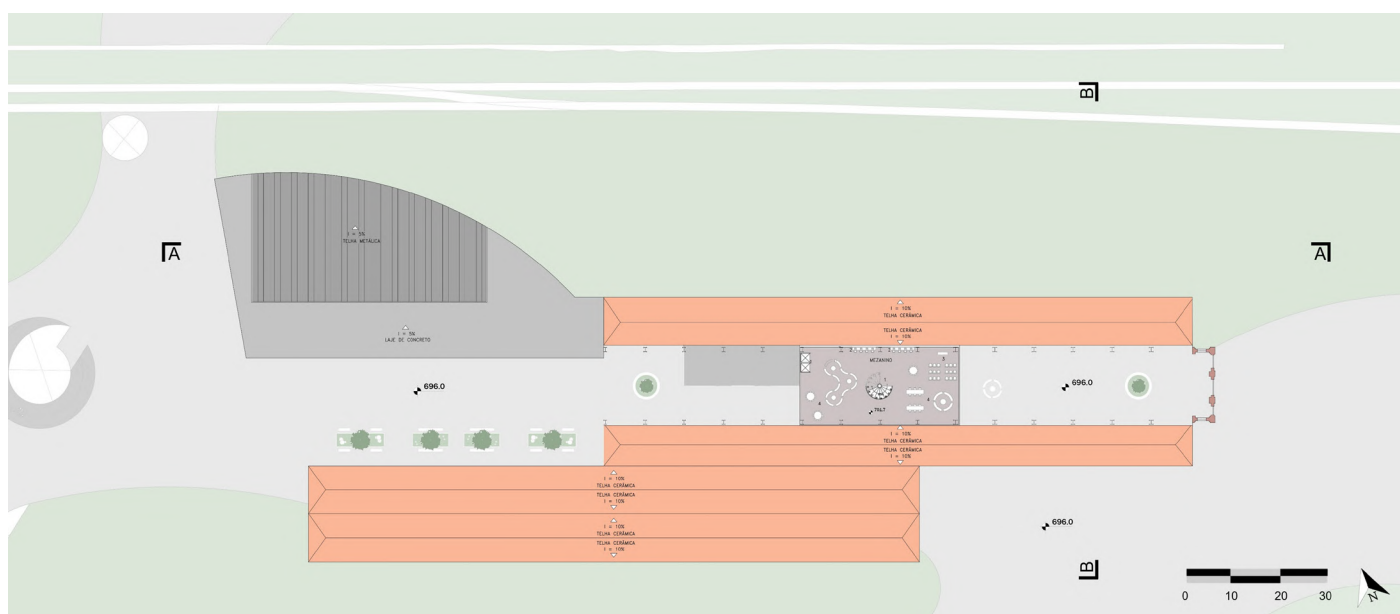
Planta baixa - Pavimento superior. Autor: imagem produzida pela equipe.
